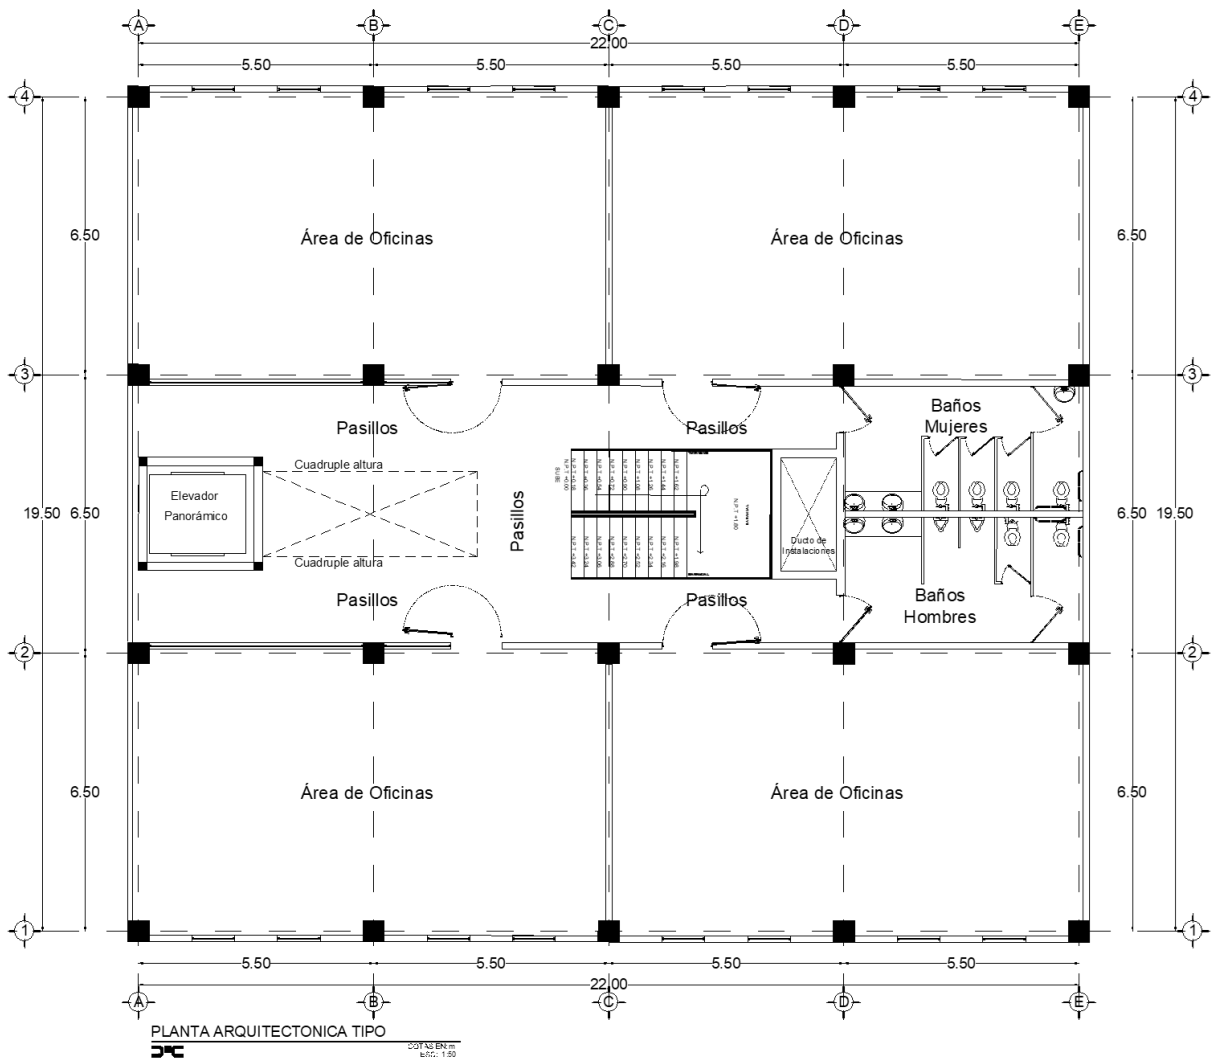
Planta Arquitectónica Tipo, Planta baja, niveles 1, 2 y 3.
